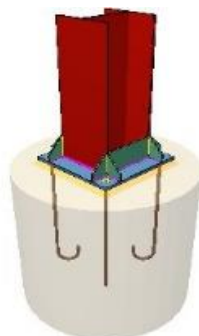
Detalhamento de ligação de um nó da estrutura.
